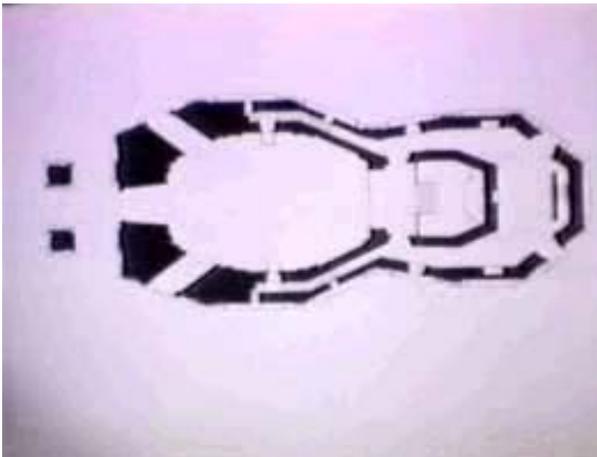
Fig G: Planta da Igreja de Nossa Senhora do Outeiro.
